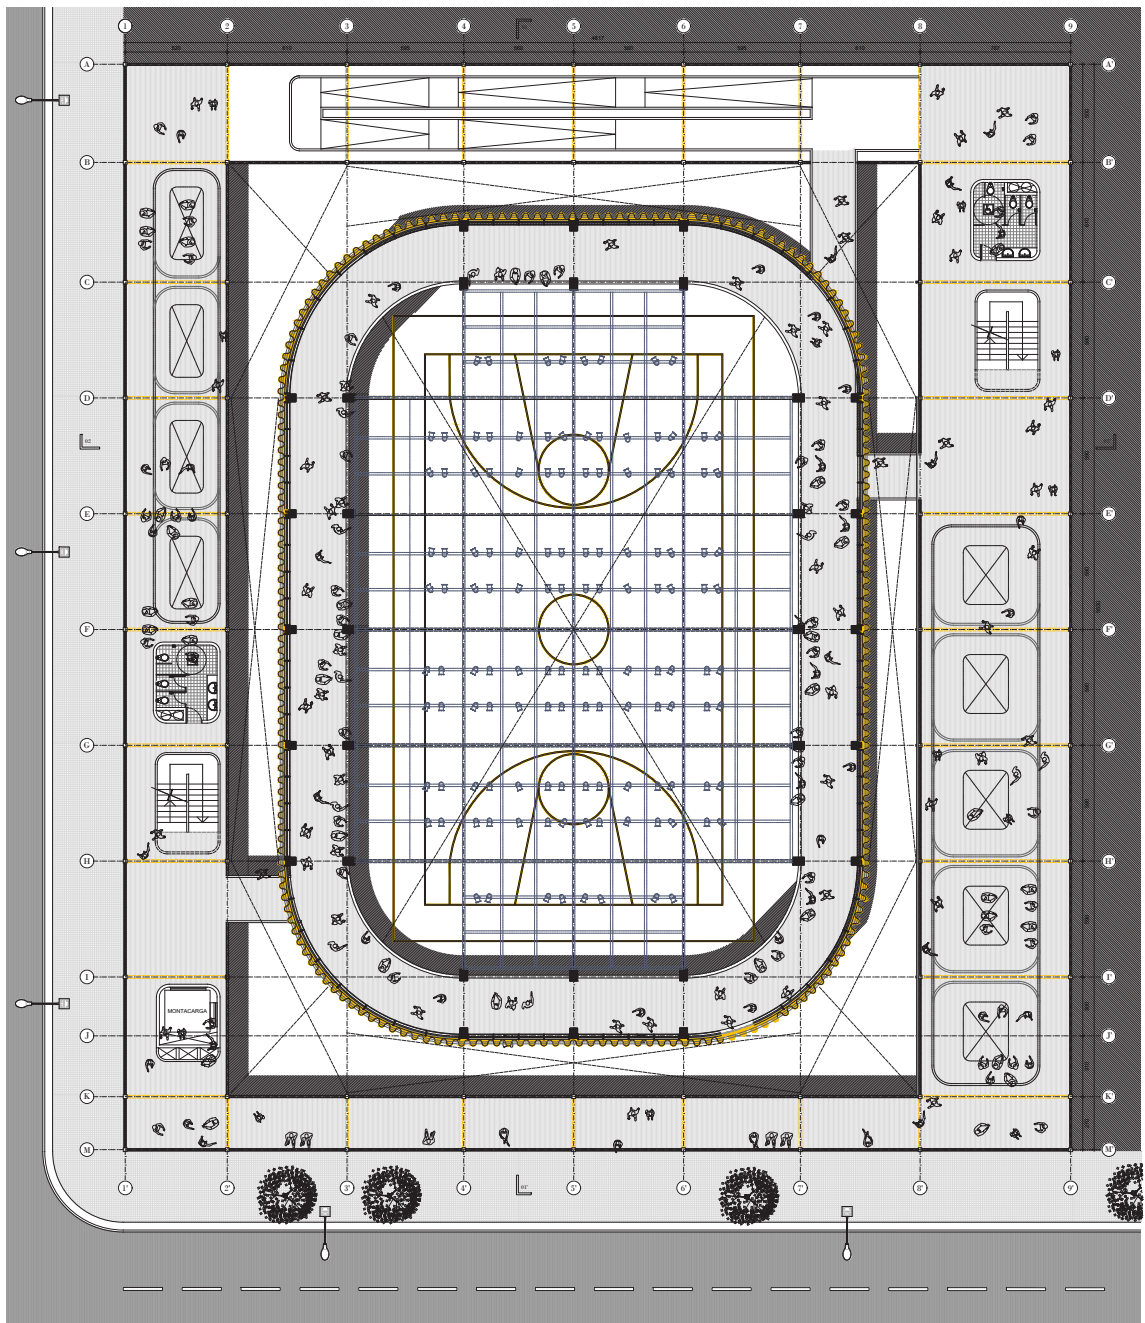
| Planimetría Genérica (Sujeto a cambios por proceso). Fuente:Autor.
